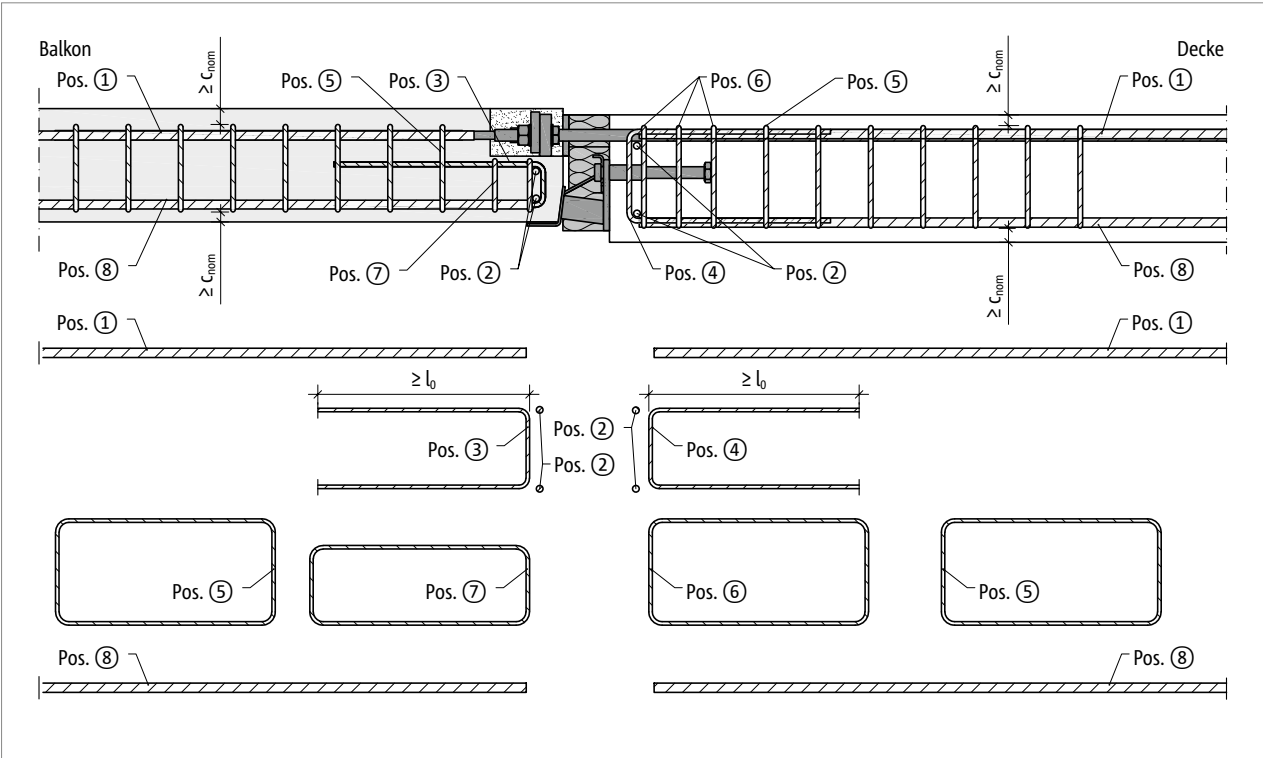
Schöck Isokorb® IQ Typ K-B: Bauseitige Bewehrung
